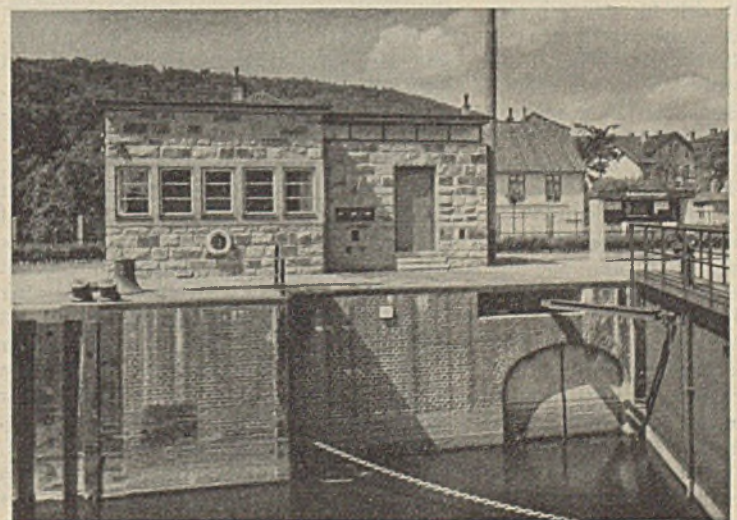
Landseite des Oberhauptes mit Maschinenhaus und Aufenthaltsraum.
